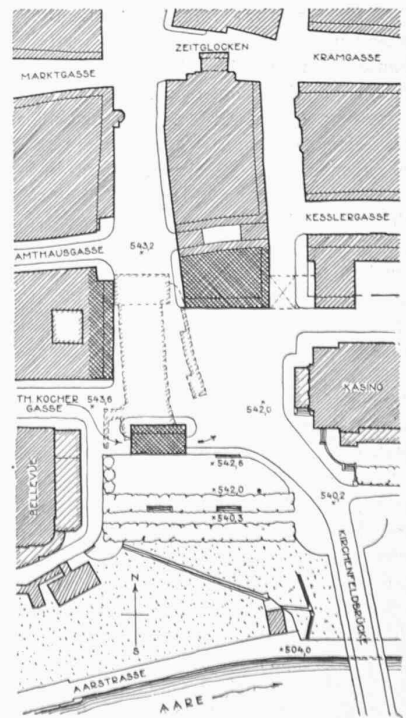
Projekt des Preisgerichtes. Lageplan 1 : 2500.
